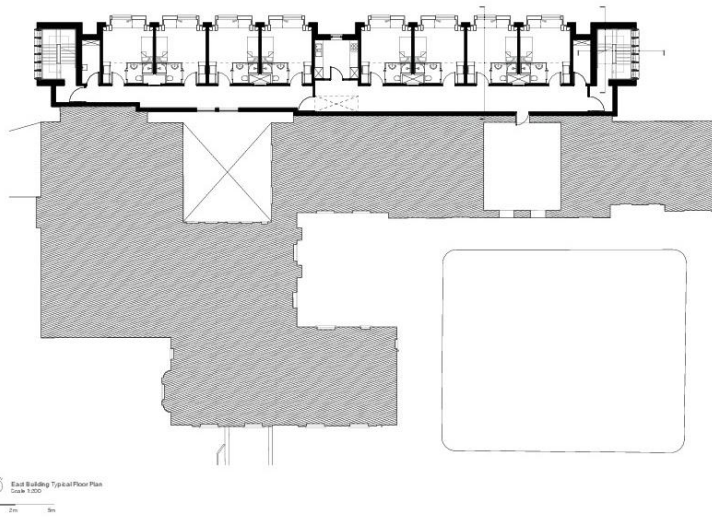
Planta tipo del edificio este, FUENTE: Arch Daily
